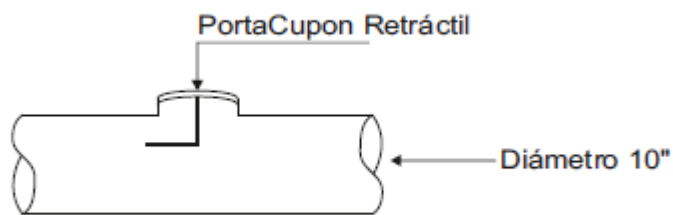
Detalle de tubería salida tanque de almacenamiento. Fuente: Los autores.
